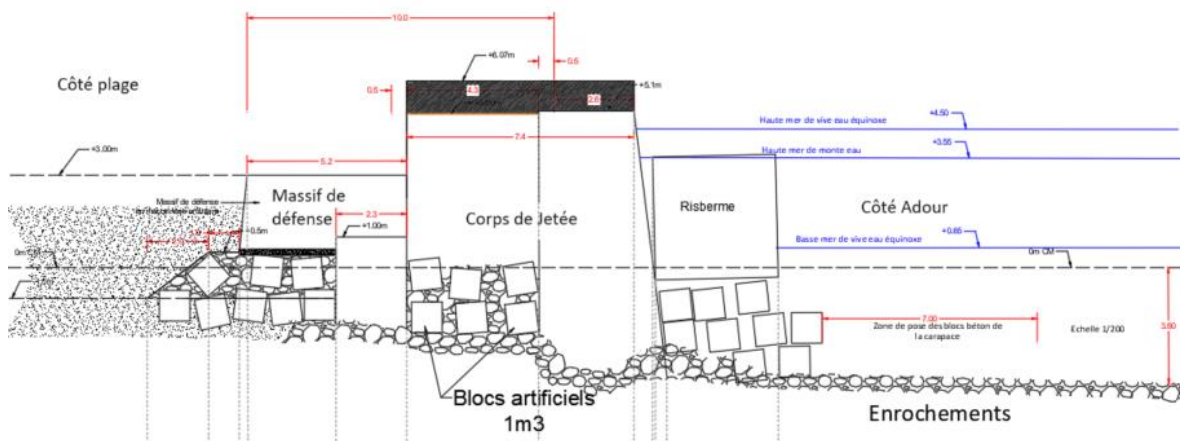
Plan de principe de coupe PM150 (section courante aval)
